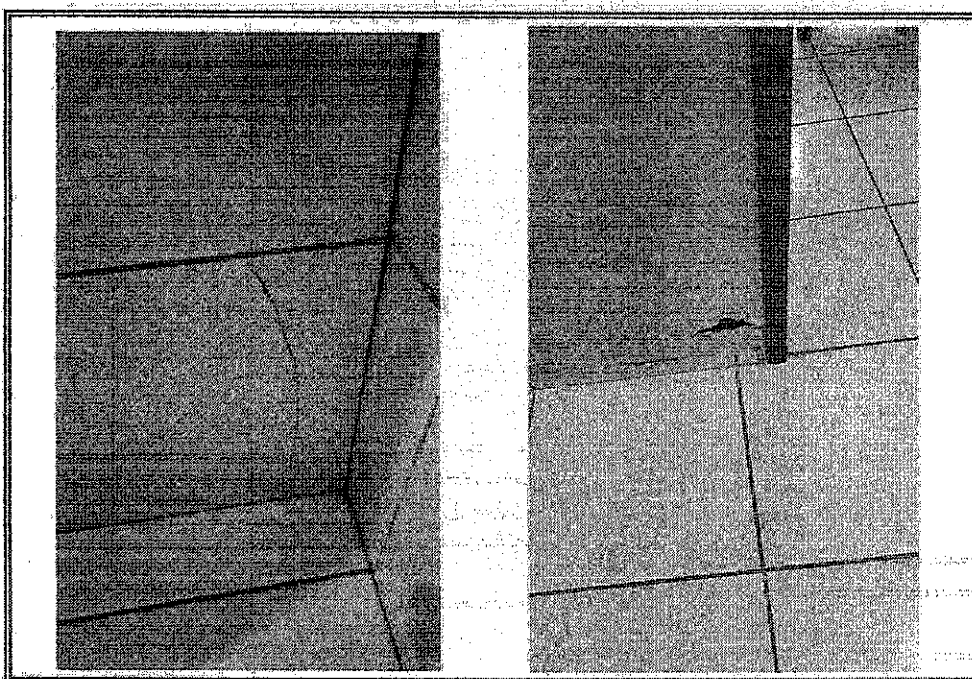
Piso cerâmico rachado - ALTO FELIZ
